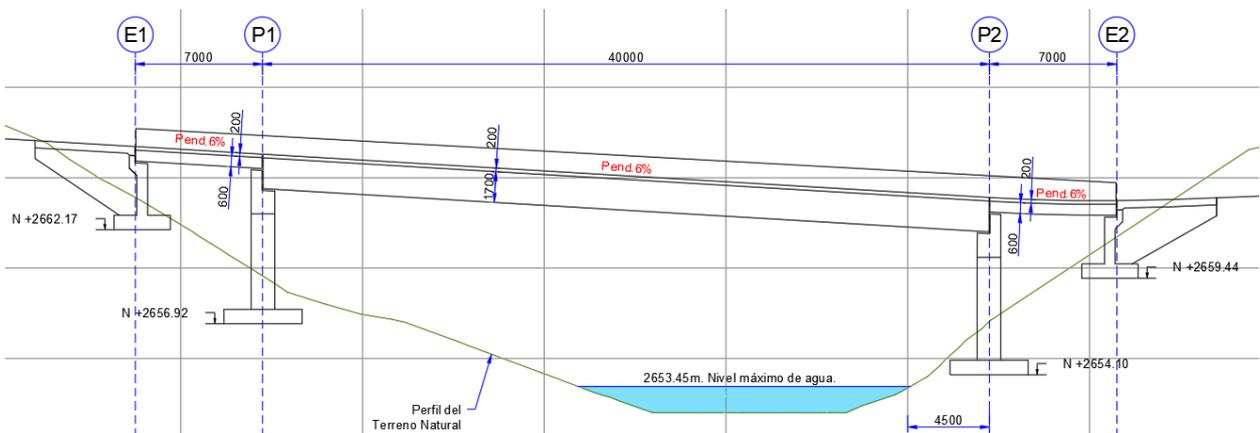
Alternativa estructural 2 [Elaboración propia]
